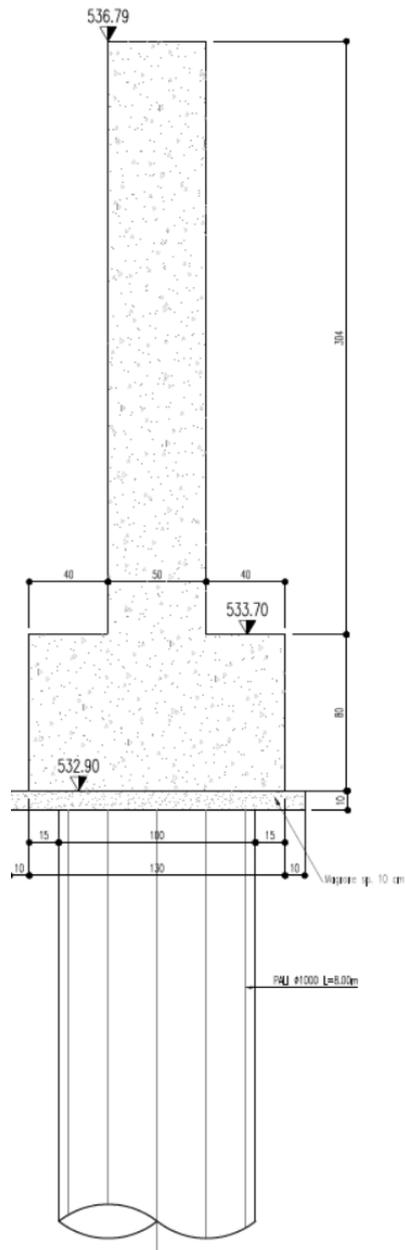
Carpenteria tipo del muro con fondazione su pali ortogonale alla viabilità NV062
